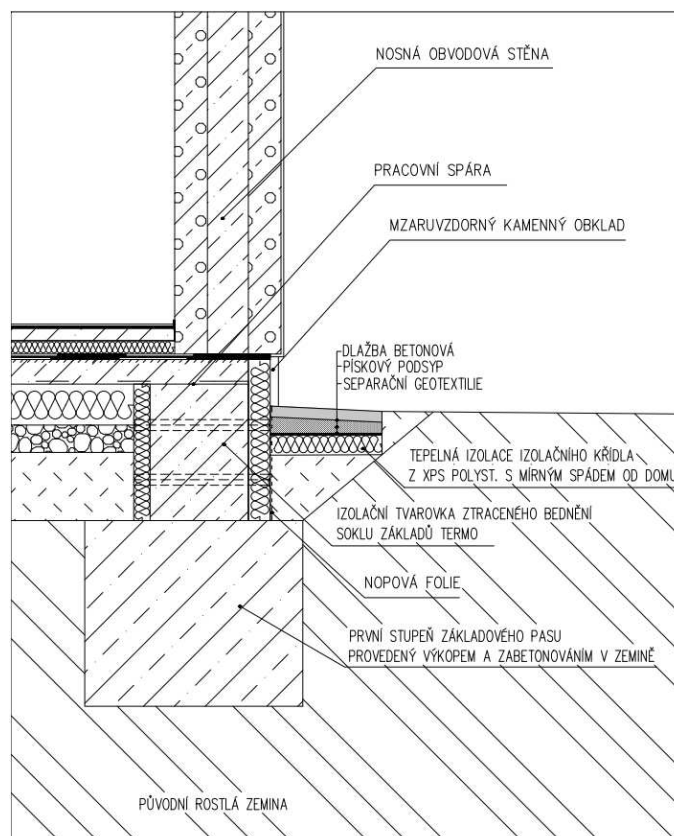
Detail soklu základových pásů z tvarovek TERMO [33]
